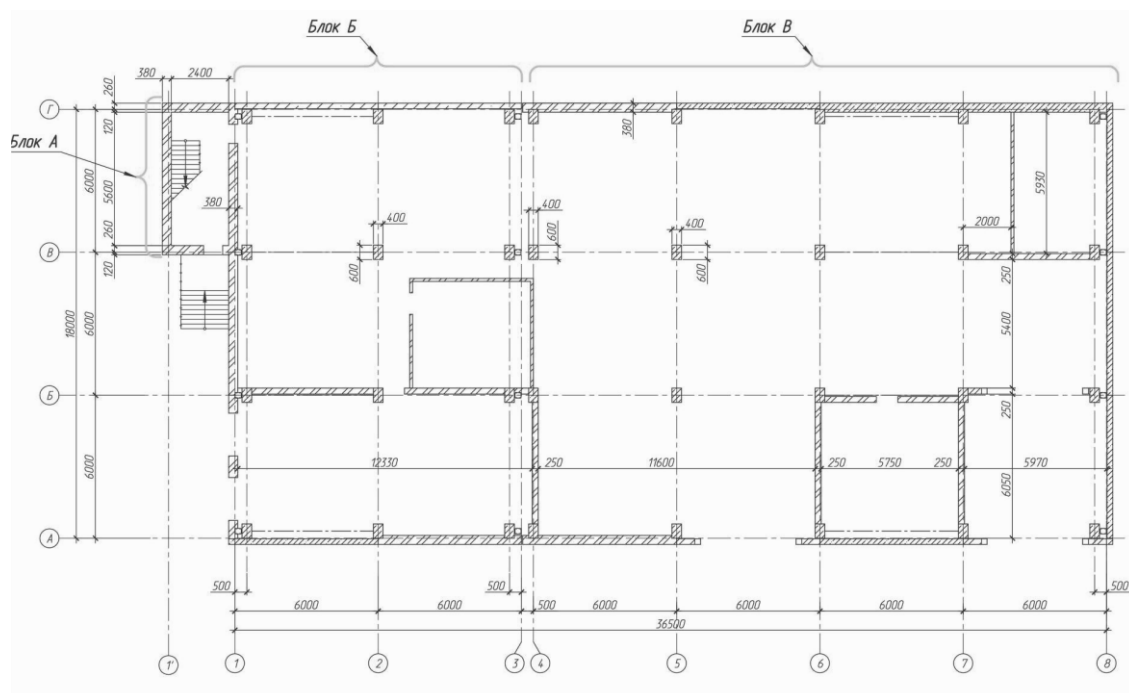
План здания обогатительной фабрики на отм. 0,000
